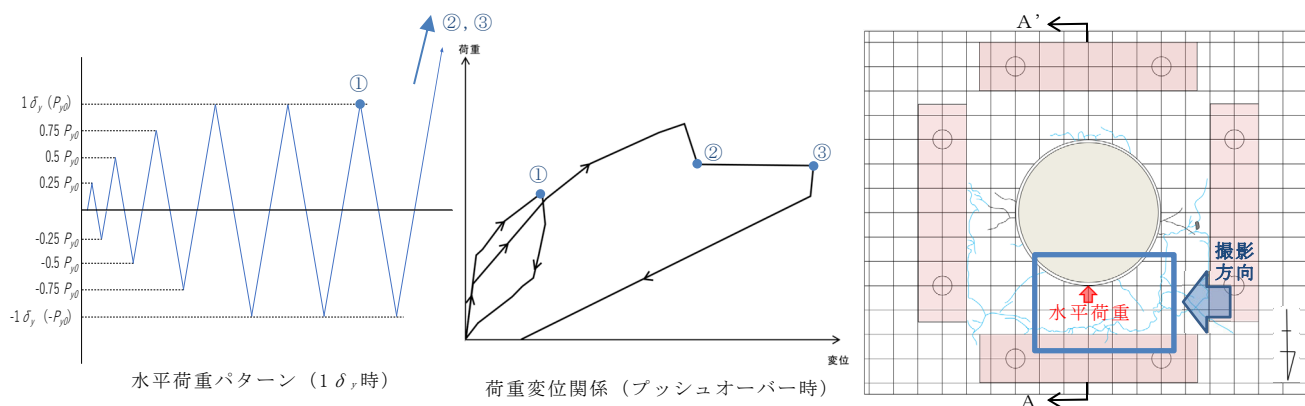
杭頭内部のひび割れ状況図
